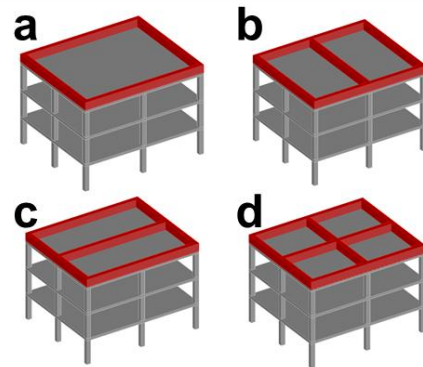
Ejemplos de posibles disposiciones de vigas de refuerzo, ordenadas de menor (a) a mayor (d) longitud total.
